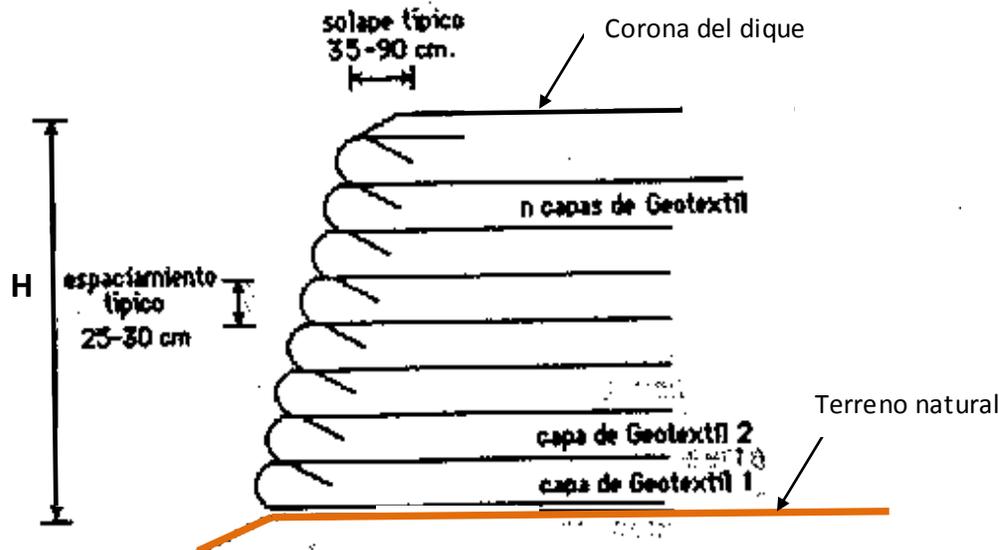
Sección transversal típica de un talud reforzado con geotextil
